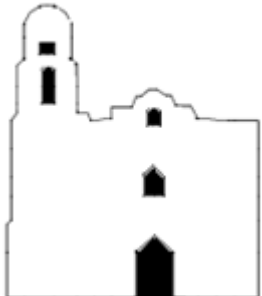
Geometría de la fachada de la Parroquia de San Juan Bautista (dimensiones en m)
